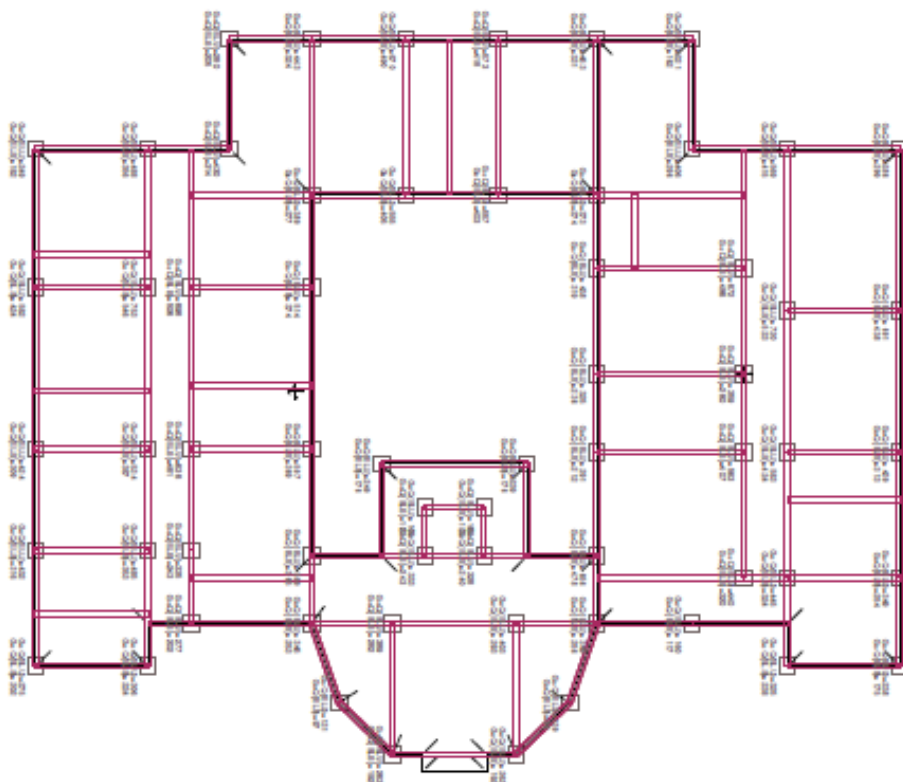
Plan des fondations / descente de charge – Fondation profonde
